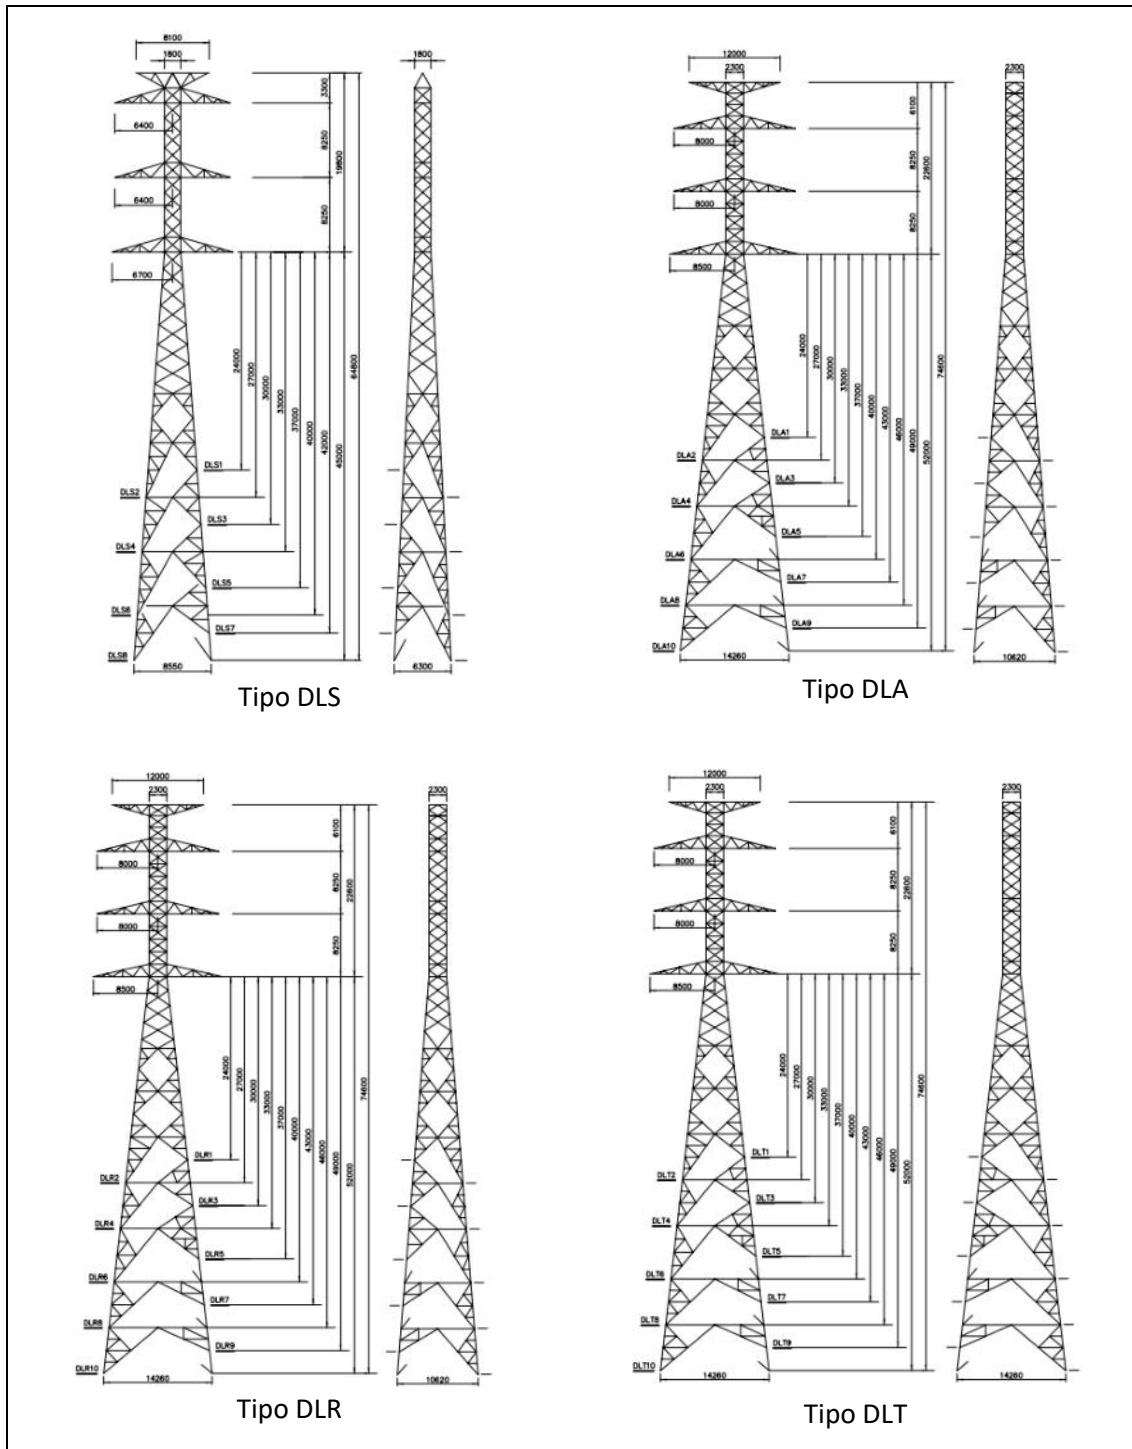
Tipo de apoios. (Fonte: EIA reformulado)
